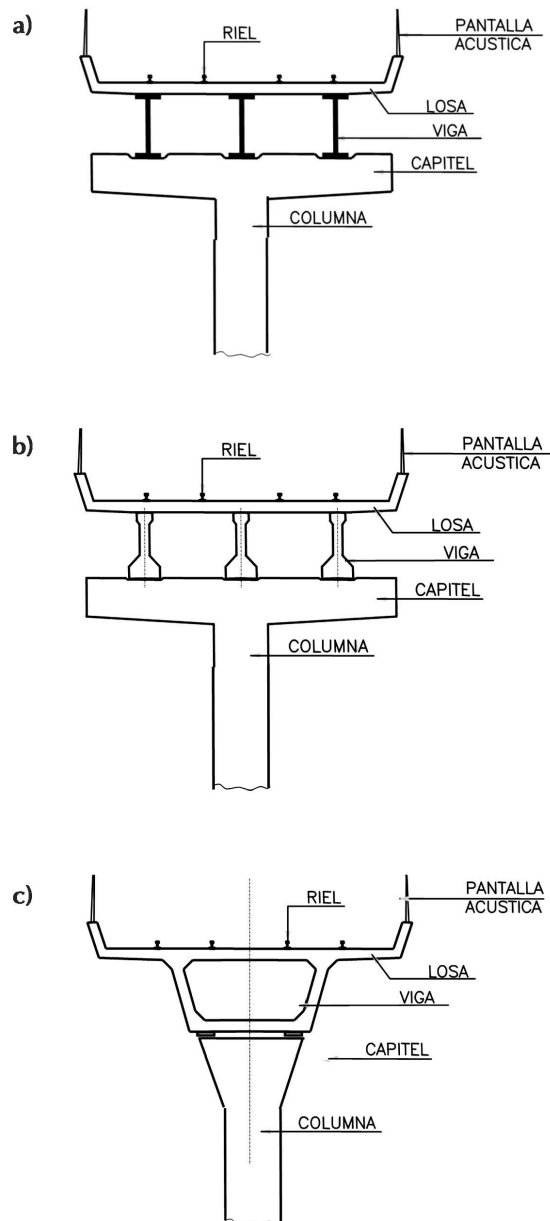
a) Vigas prefabricadas de acero doble, b) Vigas prefabricadas de hormigón y c) Vigas prefabricadas tipo cajón
